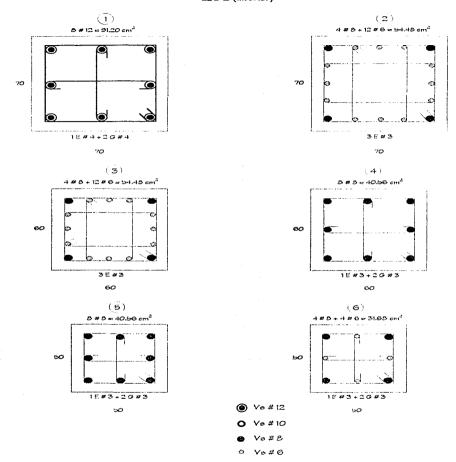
Tipos de armados de las columnas del eje 2, edificio de 7 niveles discriado en la zona !!
